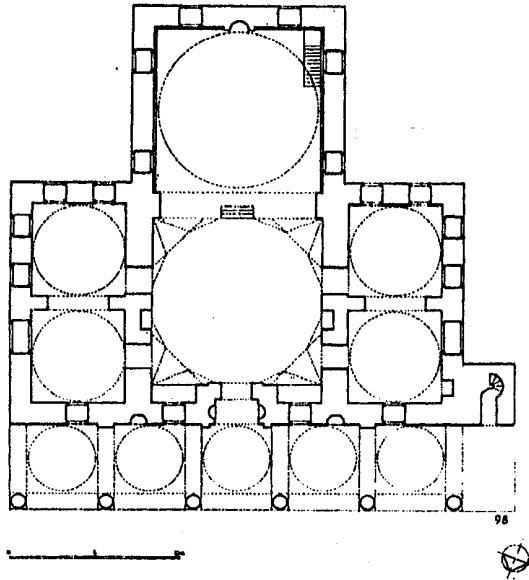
مسقط أفقي للجامع الاخضر (يشيل جامع) في بورصة
